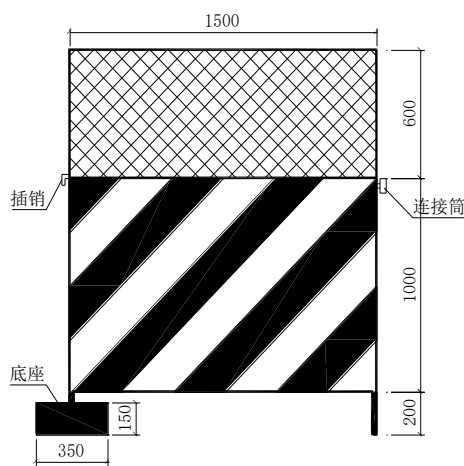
钢围挡立面示意图 (单位: mm)
